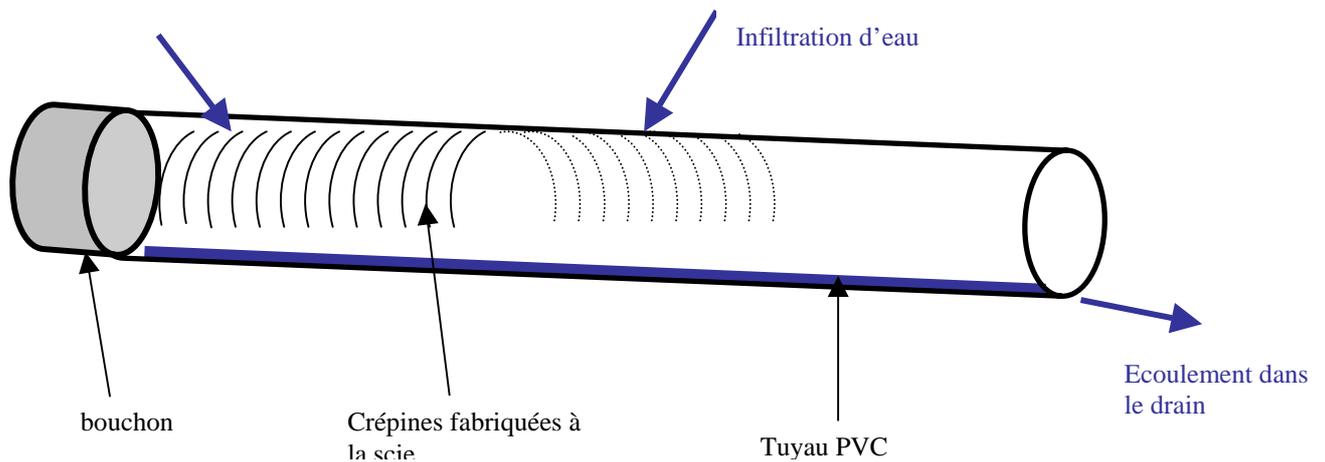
Drain fabriqué localement avec du Tuyau PVC (diamètre 90).
